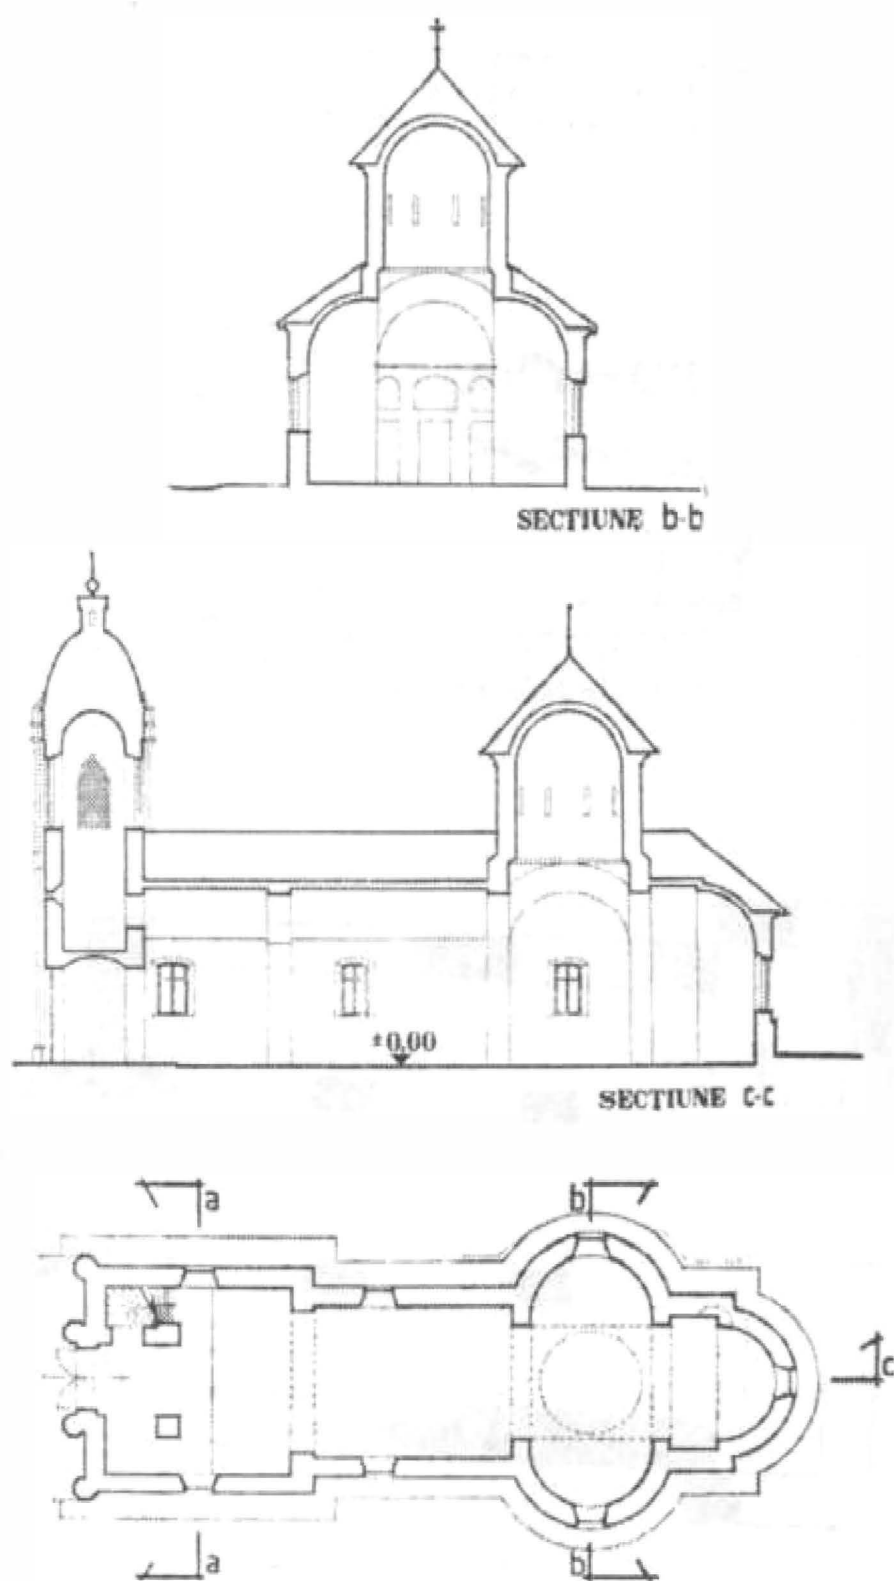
Baziaș. Querschnitt , Längsschnitt und Grundriss der Klosterkirche (XV Jh.)
